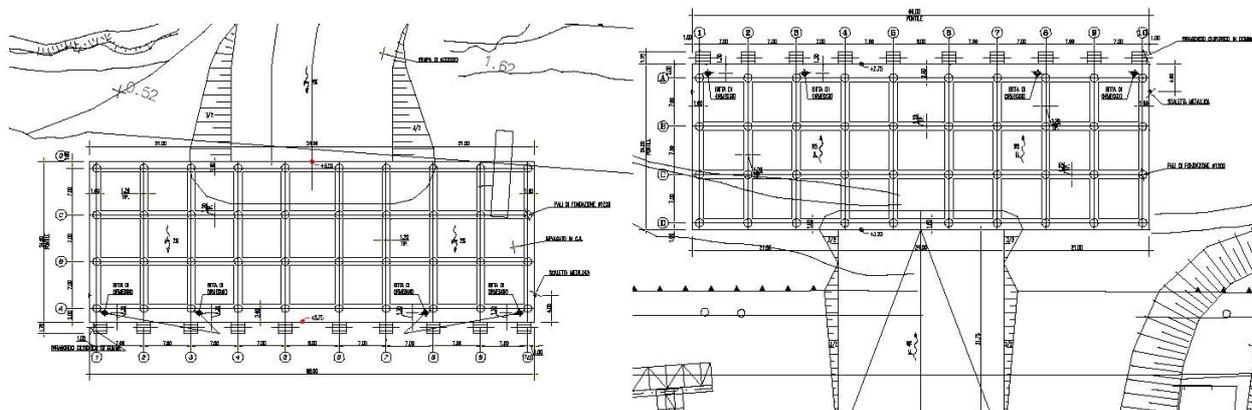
1, Planimetria di intervento pontili lato Ganzirri
